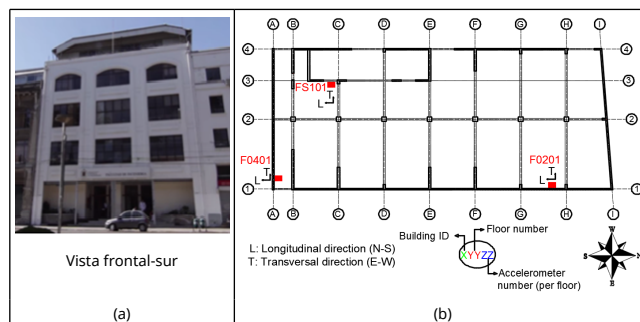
(a) Vista frontal de la estructura bajo estudio y (b) plano estructural de la planta de la estructura y ubicación de los acelerómetros [12].
